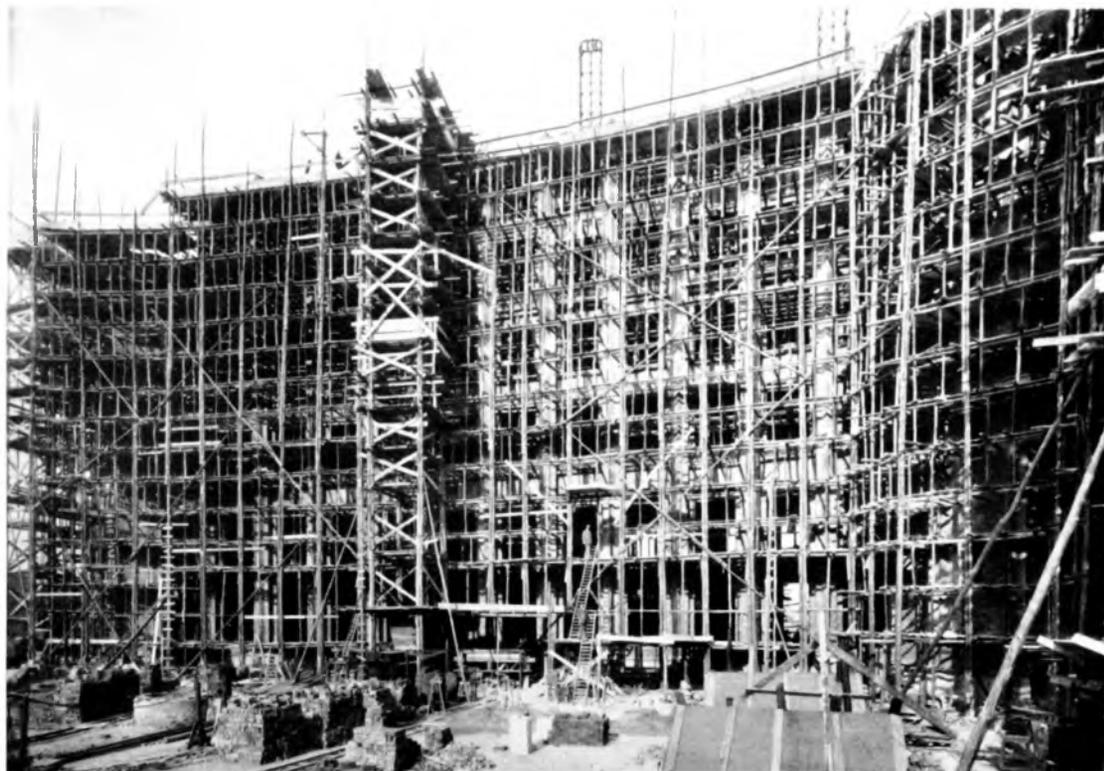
Stangenrüstung und Baustoffaufzug an der Berliner Straße, Decke des V. Obergeschosses ist gegossen, vorn Kantlinendecke
